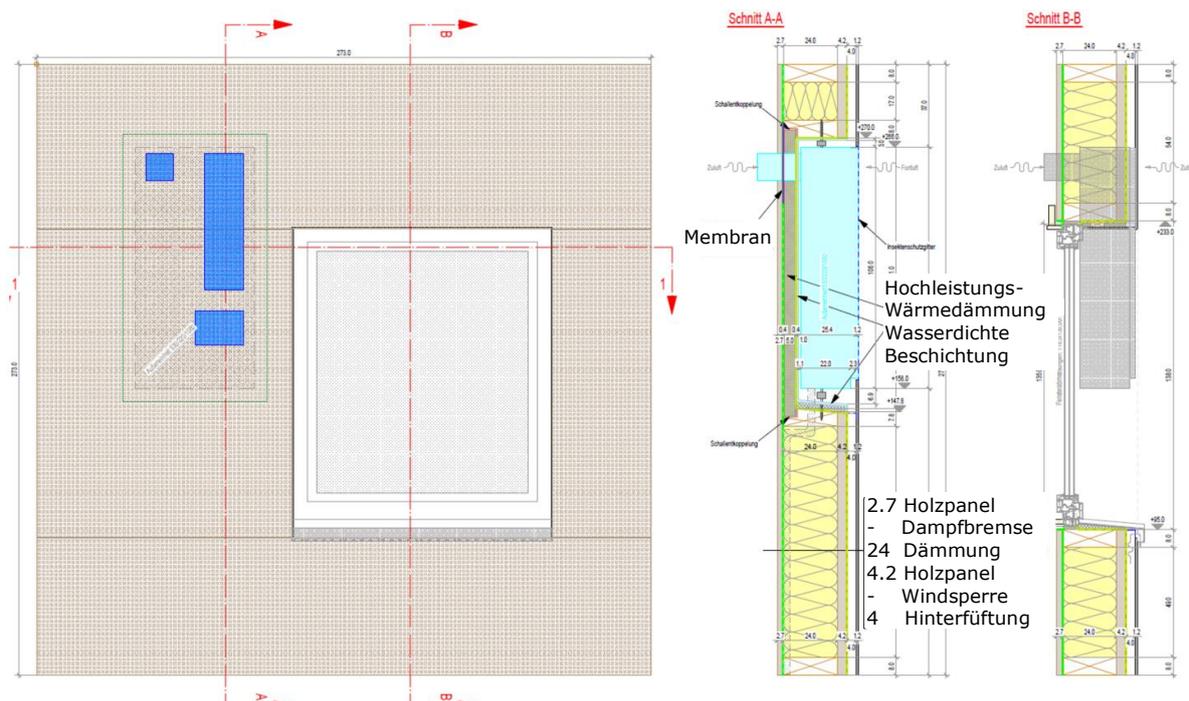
Aufbau der Testfassade mit integrierter Außeneinheit (Holzbau Kulmer)
